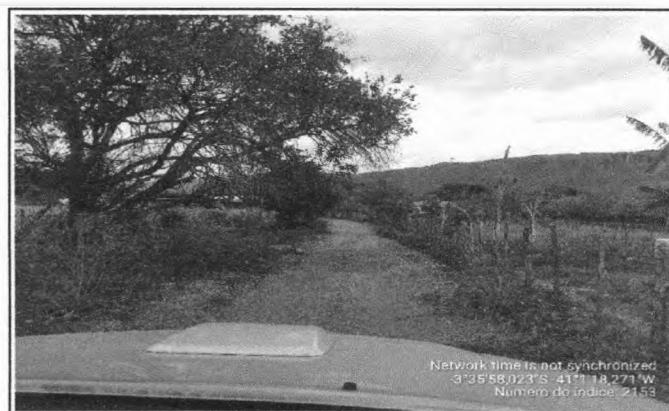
LOCAL DA CONSTRUÇÃO DO BUEIRO
